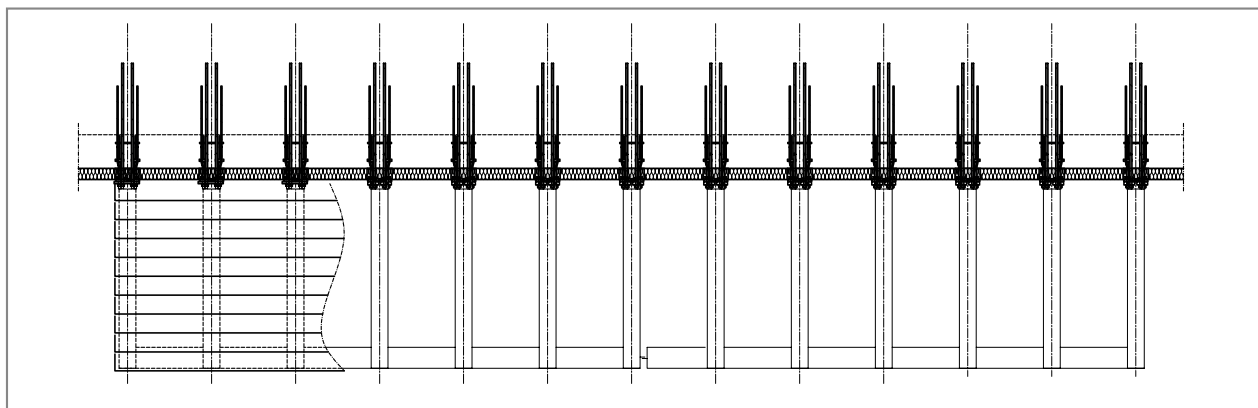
Schöck Isokorb® T tipo SKP: balcone a sbalzo
